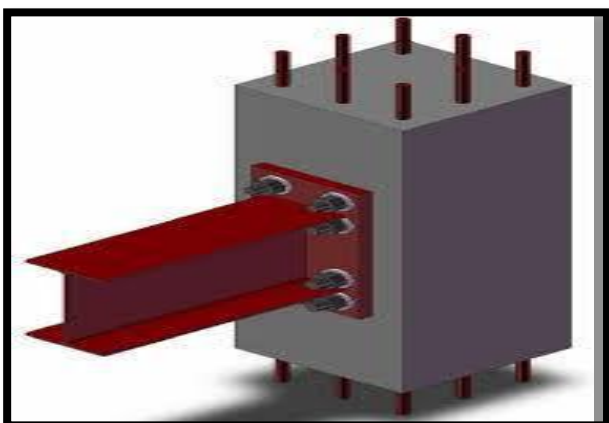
détail d'assemblage poteau béton armé / poutre métallique
